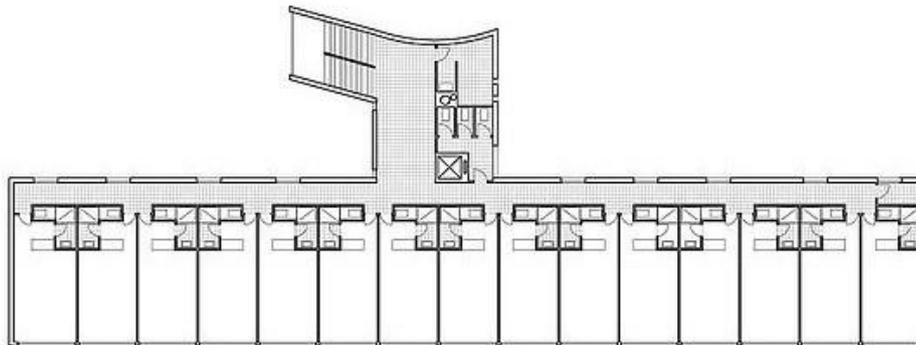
Planta nivel 0 Pabellón Suizo
